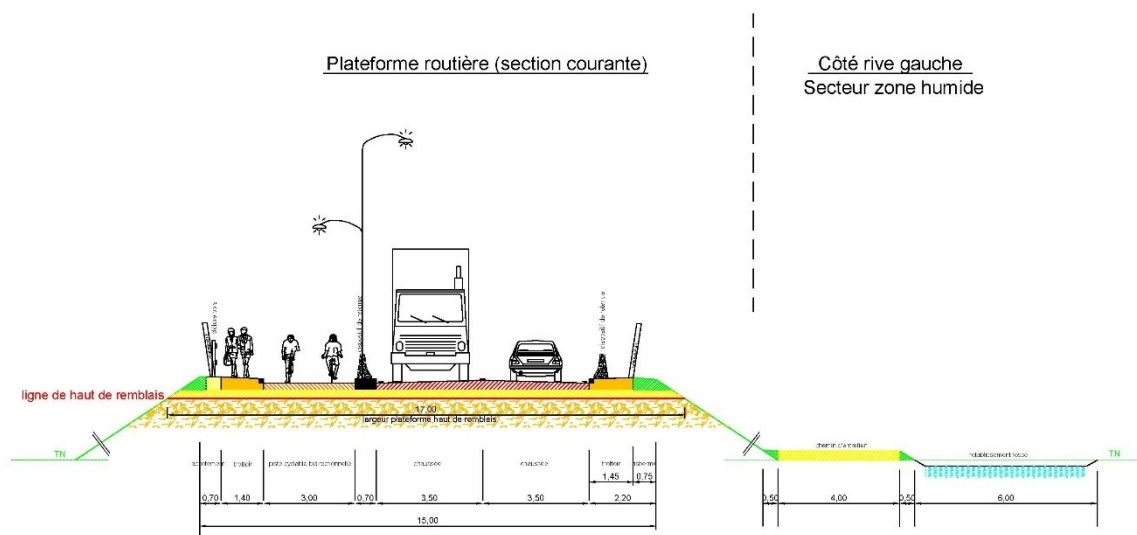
Profil en travers type des voiries de raccordement au futur pont
